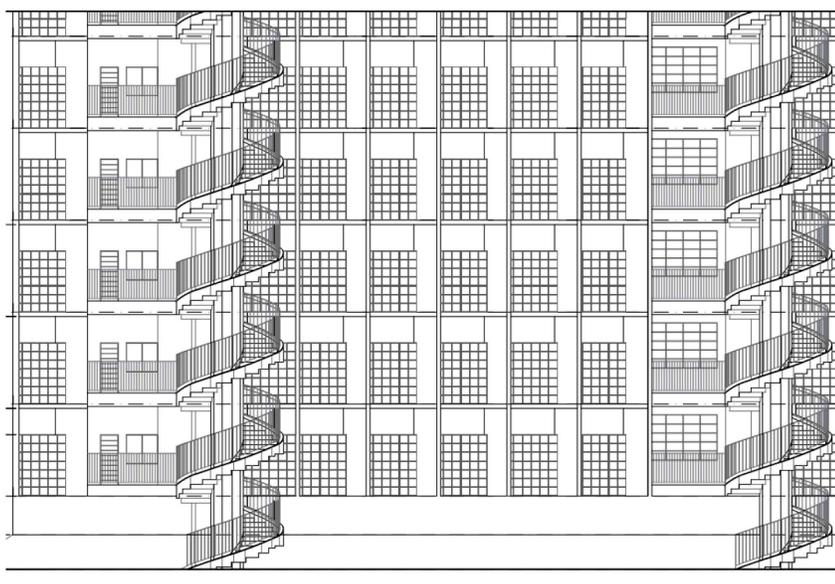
As built* parcial da Fachada Posterior (Blocos F e E)
